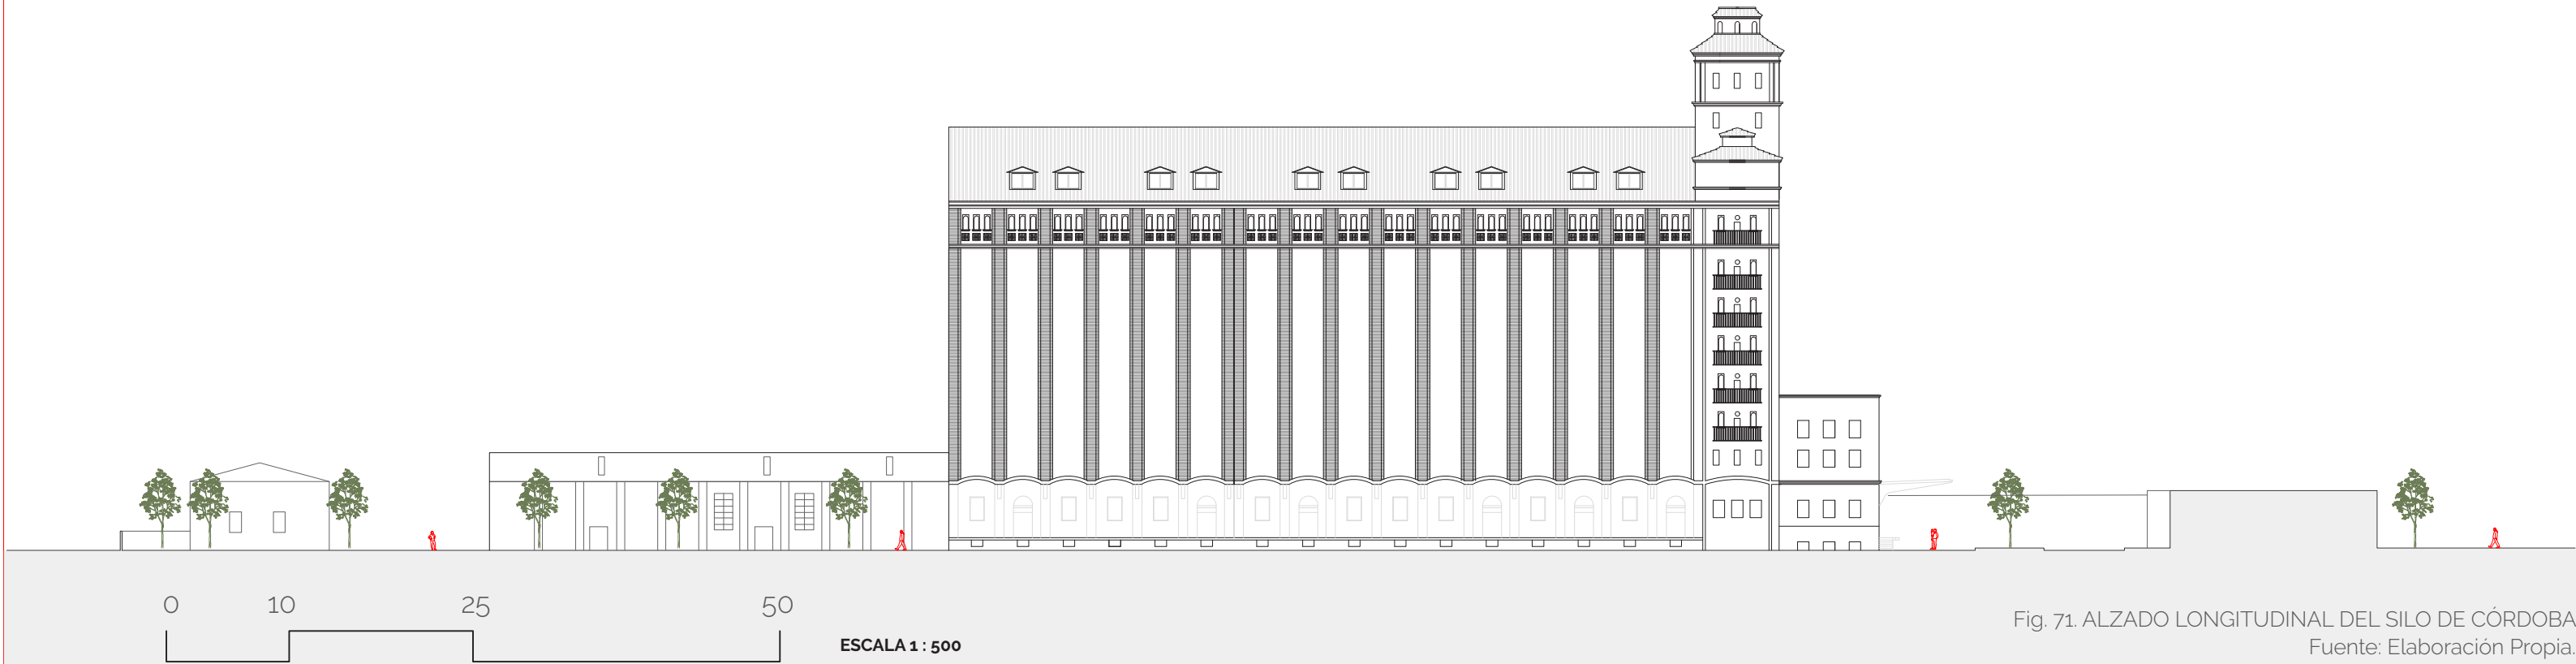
ALZADO LONGITUDINAL DEL SILO DE CÓRDOBA
